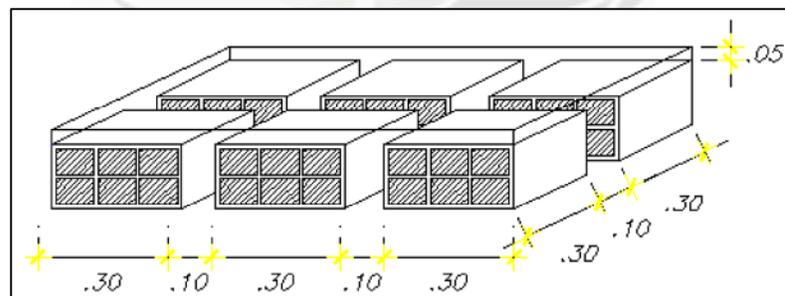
Características de Losa Aligerada Bidireccional.
